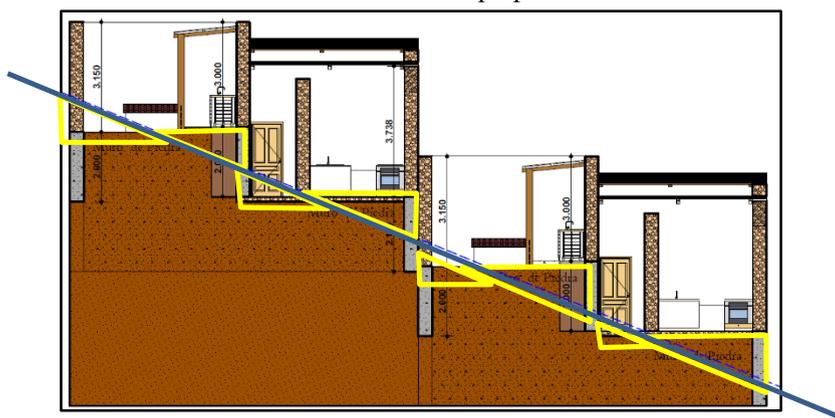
Corte de lotes, Adecuación a la topografía.
